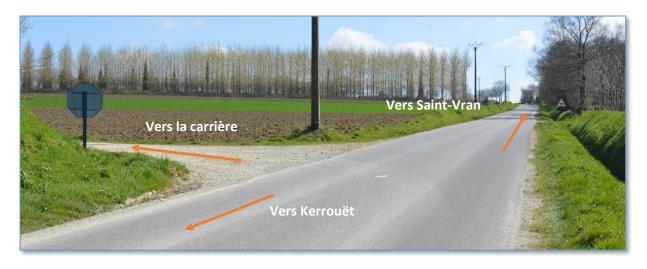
Vue 2: RD76 au niveau du croisement RD76/voie d'accès au site
